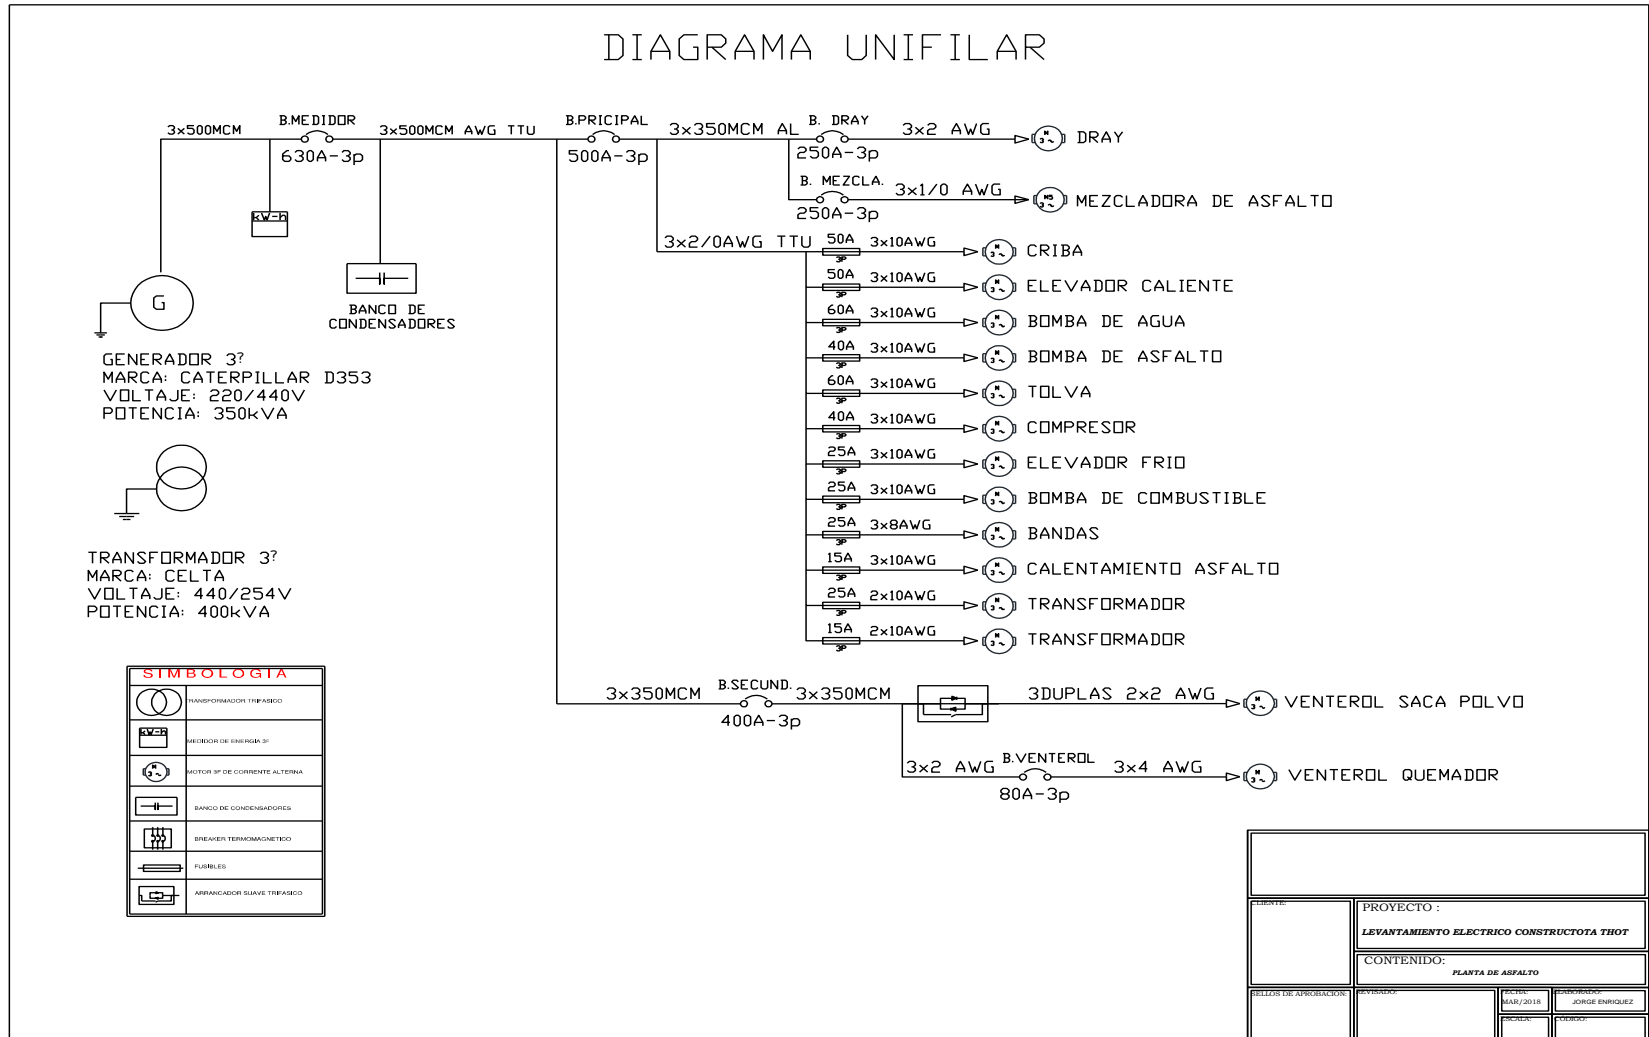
Diagrama unifilar Planta de Asfalto. (Fuente autores)
